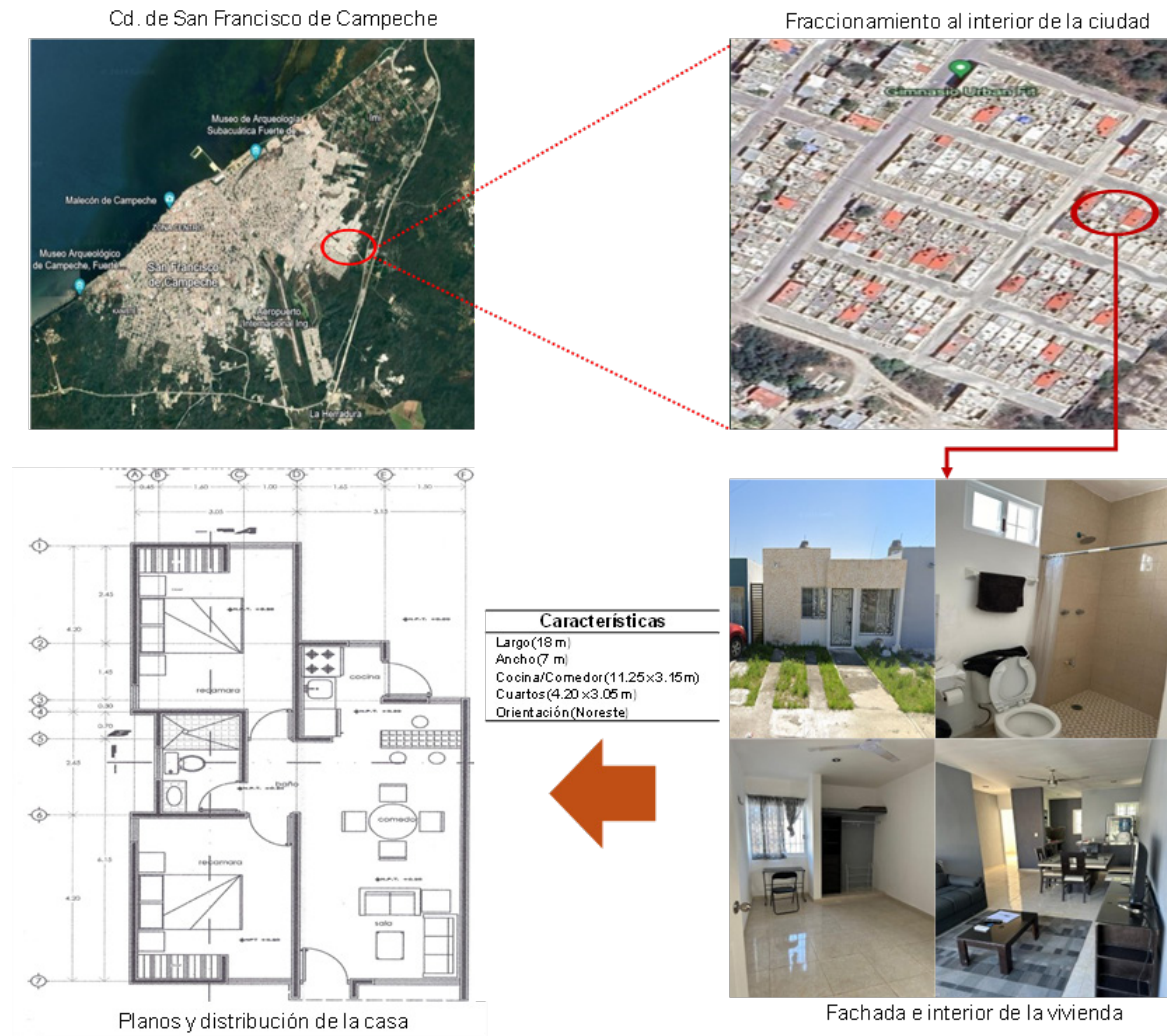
Vista aérea, fachadas, interiores y planos de vivienda del caso de estudio. Fuente: Elaboración de los Autores.
